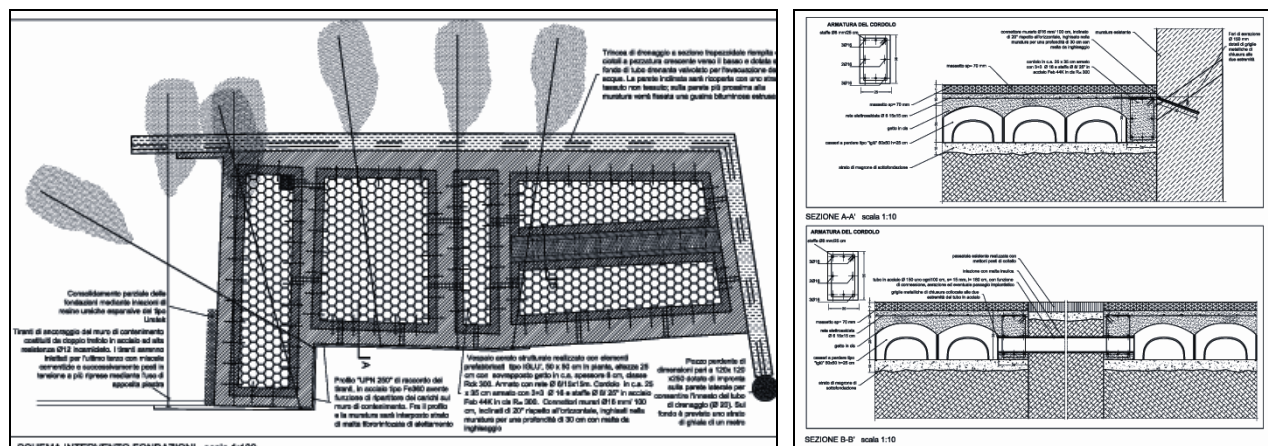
Cascina annessa al castello della Manta: interventi in fondazione.
